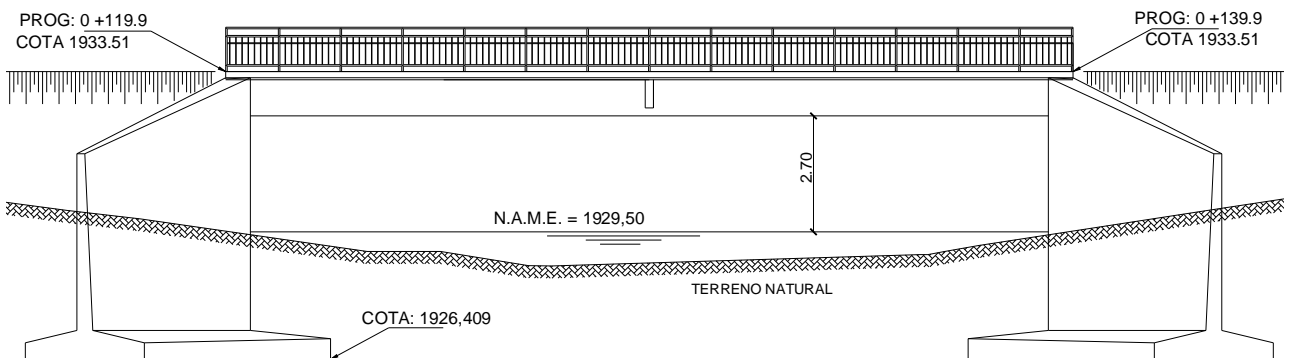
Sección Longitudinal.
